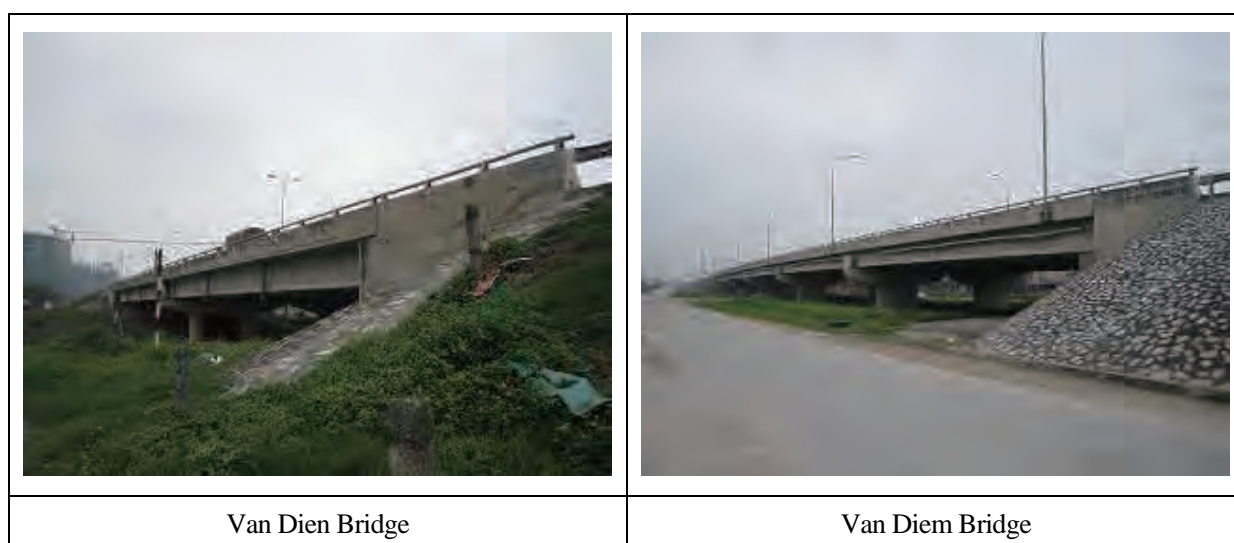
Van Dien Bridge および Van Diem Bridge の現況写真
